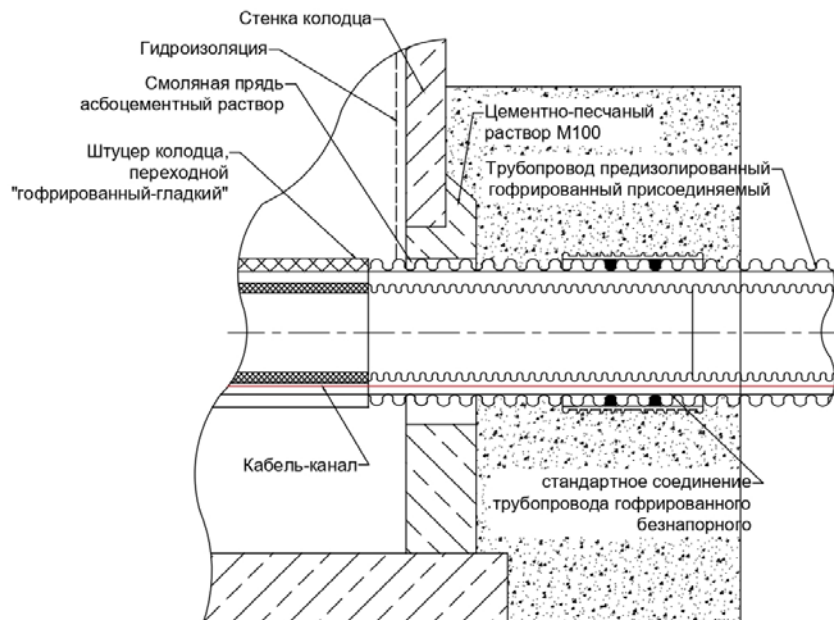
Соединение предизолированной гофрированной безнапорной трубы с штуцером сборного железобетонного колодца, в просадочных грунтах.
